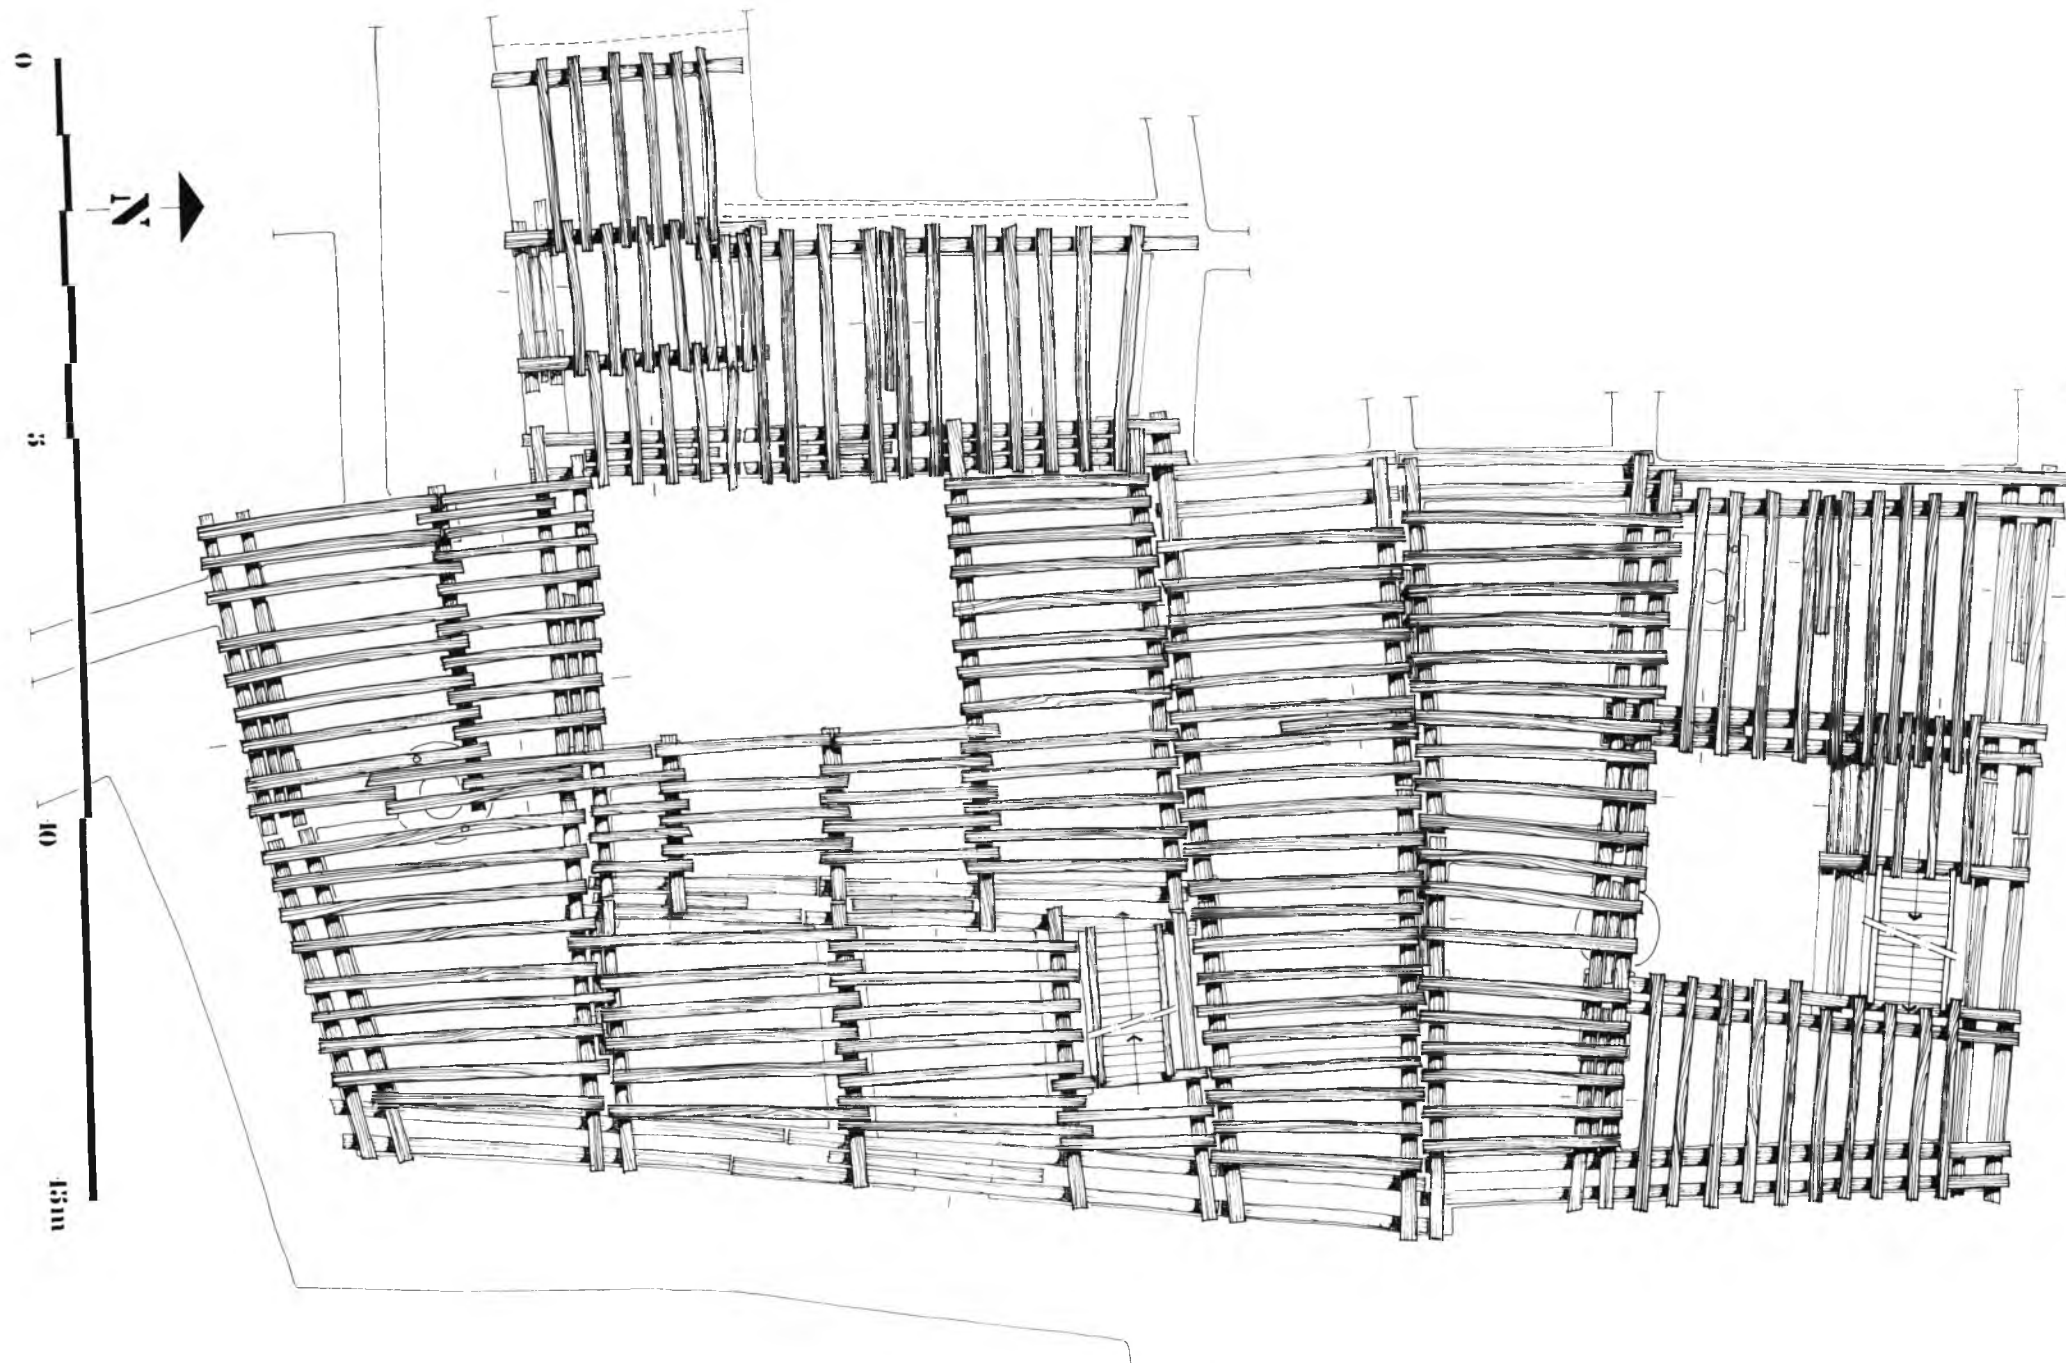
Ilot X : Maison B, plan restitué de la couverture du rez-de-chaussée.
